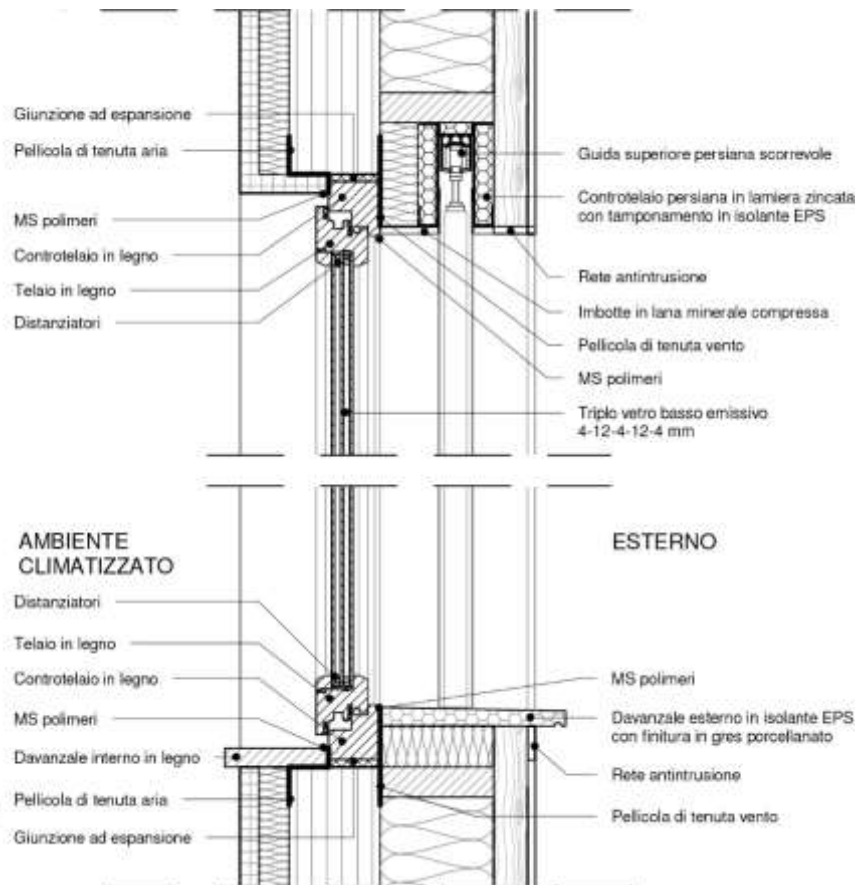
Dettaglio costruttivo della sezione verticale della finestra tipo - scala 1:10. [Fonte: elaborazione dell'autore]
